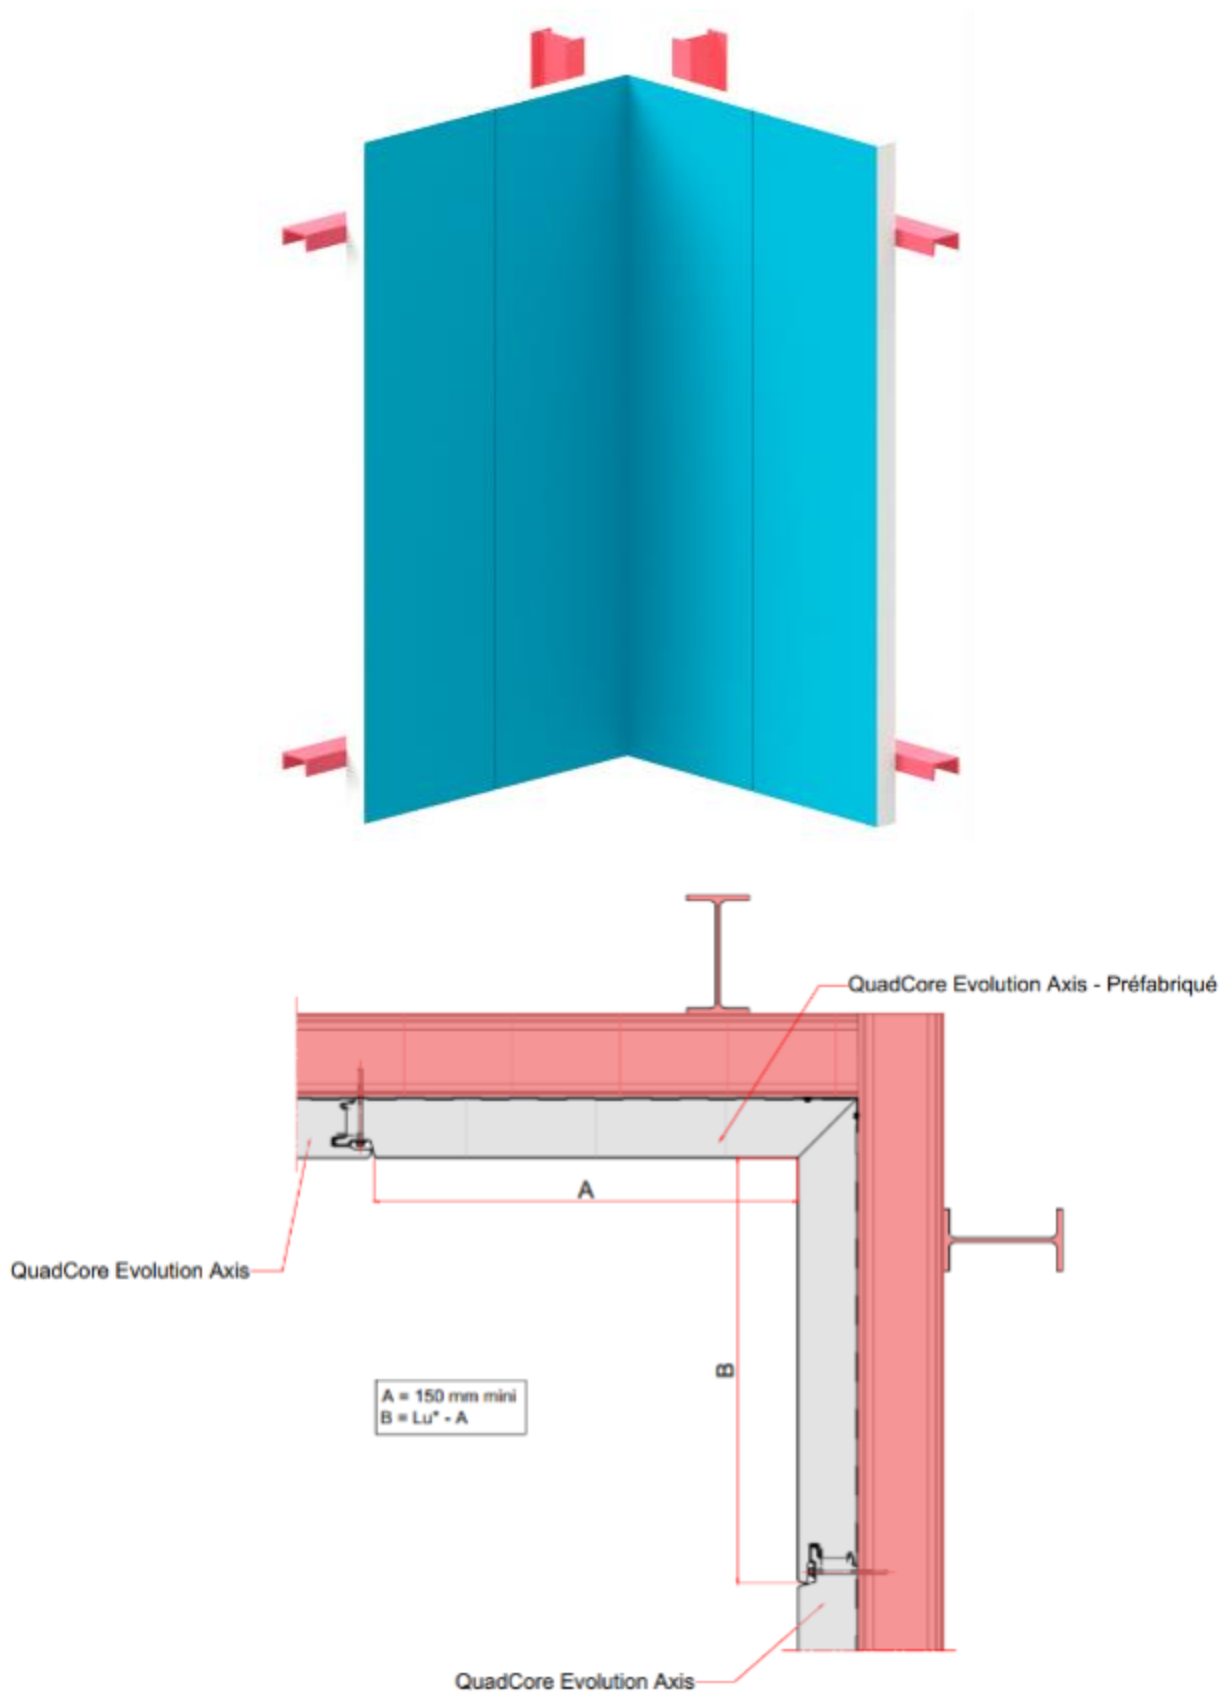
Exemple d'angle rentrant assemblé sur site en pose horizontale avec panneau sandwich isolant Louvre
